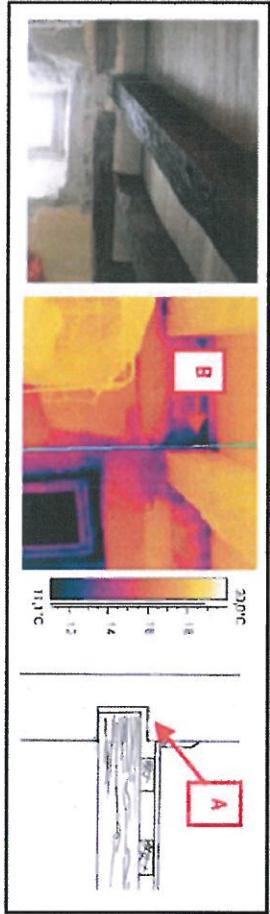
cas d'un plancher simple à poutres encastrées apparentes (bâtiment 7) :
